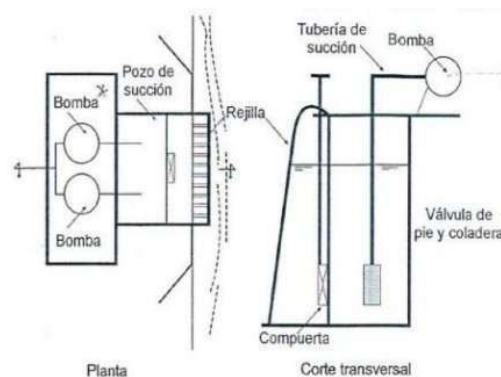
Bocatoma lateral con bombeo, en vista planta y corte[30]
